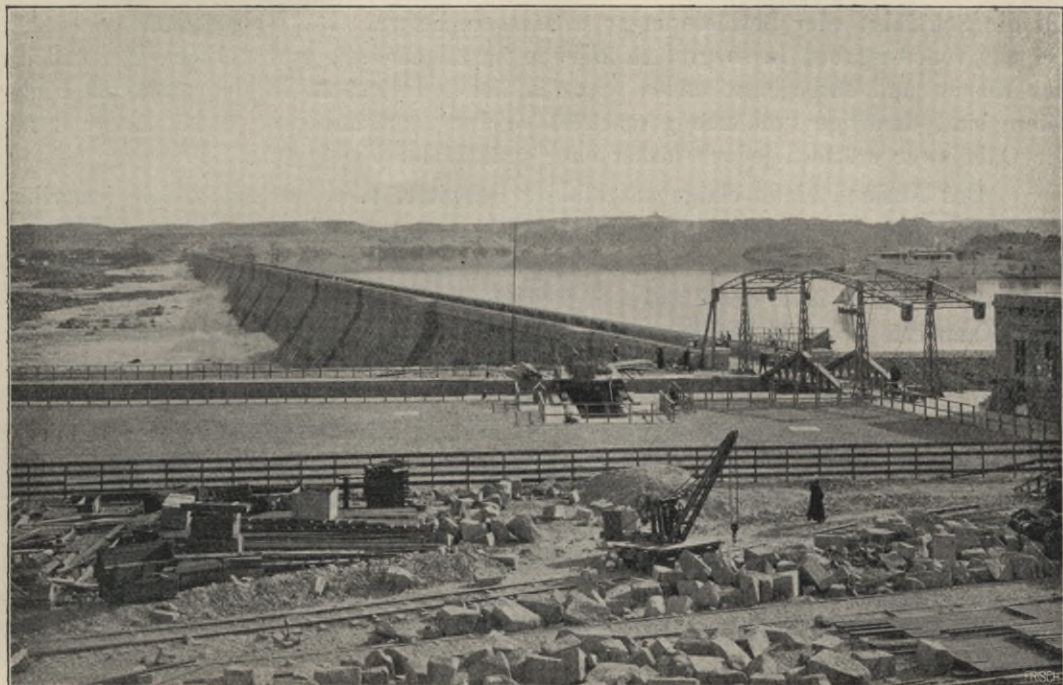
Schiffahrtsschleusen mit Portalbrücke an der Staumauer bei Assuan.
